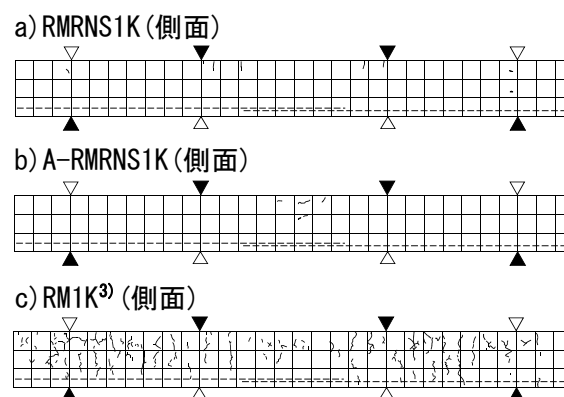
乾燥収縮ひび割れの発生状況 (材齢 1 年経過時)
